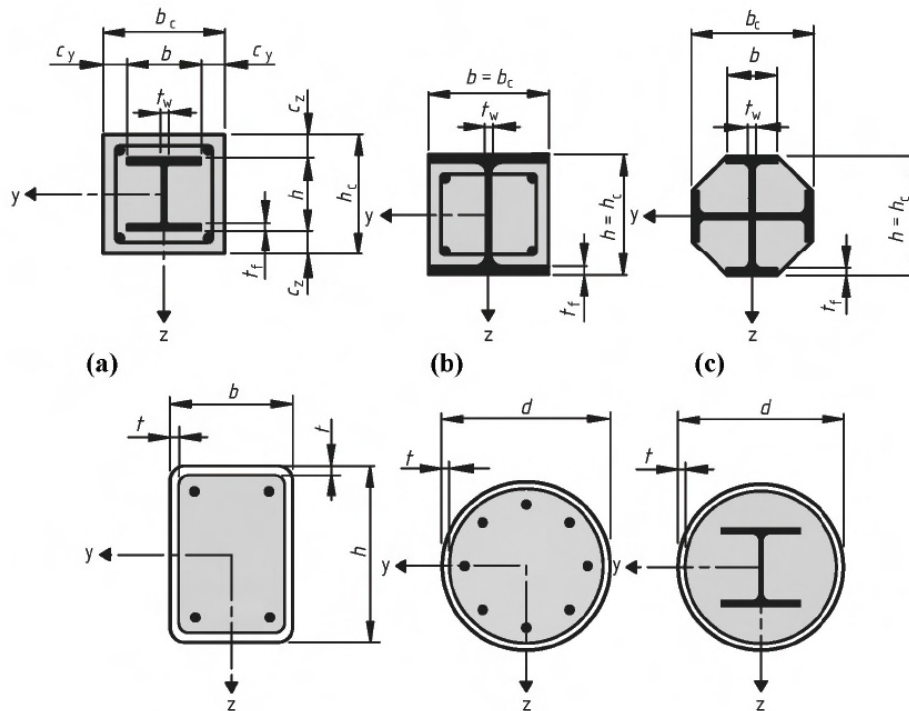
Secciones típicas de pilares mixtos y notación
